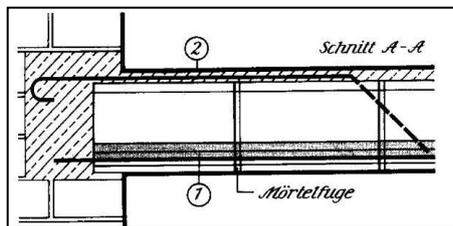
Bewehrungsführung der Kaiserdecke im Bereich des Endauflagers [1b]
